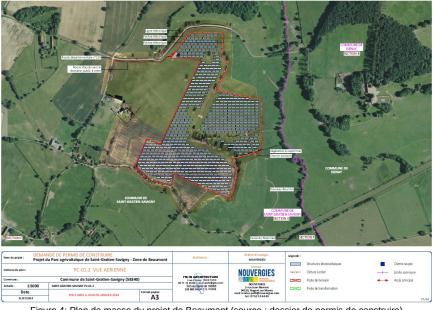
Plan de masse du projet de Beaumont (source : dossier de permis de construire)
